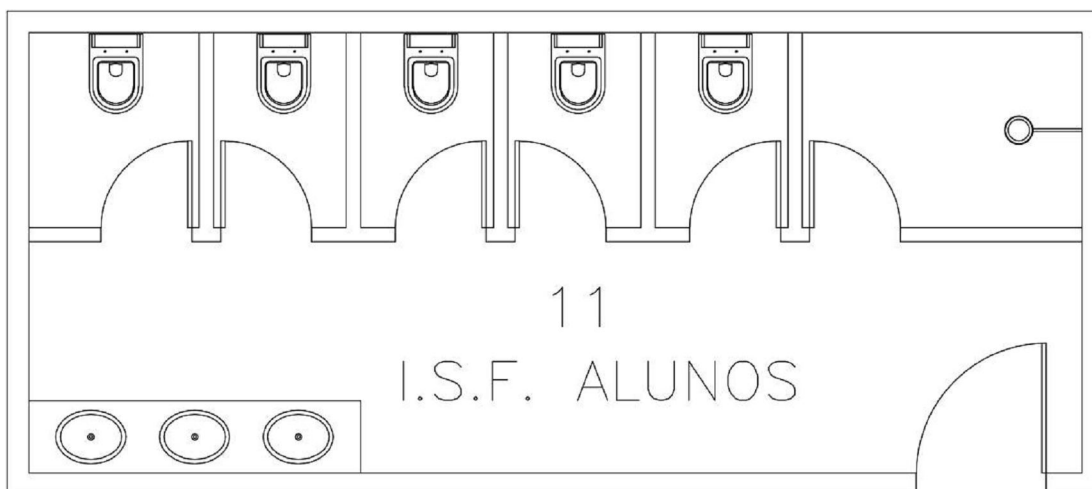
Planta Baixa sugerida Sanitários feminino.
